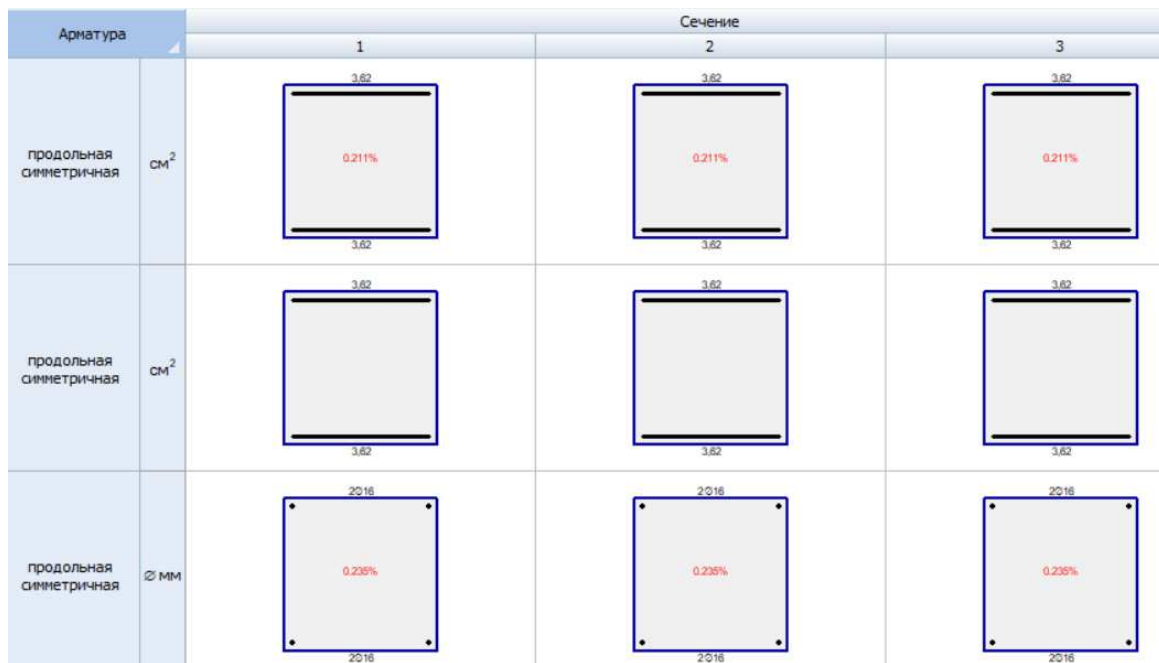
Сечение арматуры (продольной симметричной) колонны
